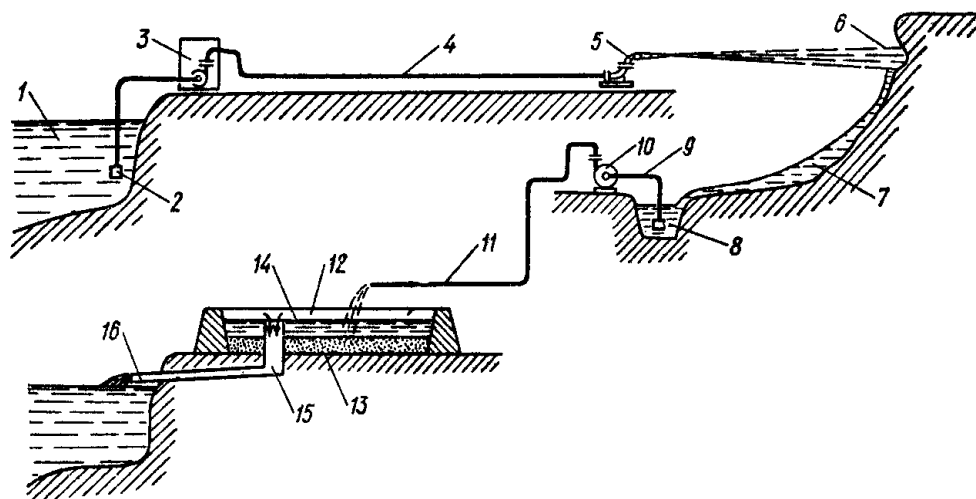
Общая схема гидромониторной разработки грунта: 1 – источник водоснабжения; 2 – водозаборное устройство; 3 – насосная станция; 4 – напорный водопровод; 5 – гидромонитор; 6 – забой; 7 – размывтый грунт (пульпа); 8 – зумпф (колодец для сбора пульпы); 9 – пульповсасывающее устройство; 10 – грунтовой насос; 11 – пульповод; 12 – участок укладки пульпы (карта); 13 – осевший грунт; 14 – осветленная вода; 15 – шандорный колодец для отвода осветленной воды; 16 – лоток для сброса осветленной воды.
